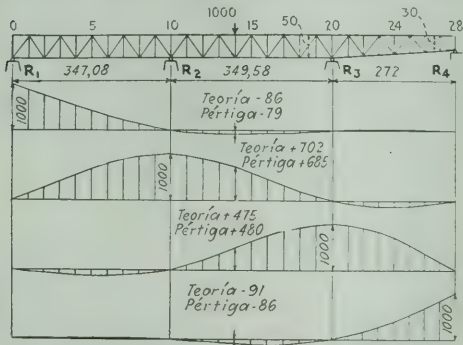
VIGA CONTINUA ARMADA DE 968 PIES 5 PULG. (295.25 M) DEL PUENTE SOBRE EL RÍO ALLEGHENY
